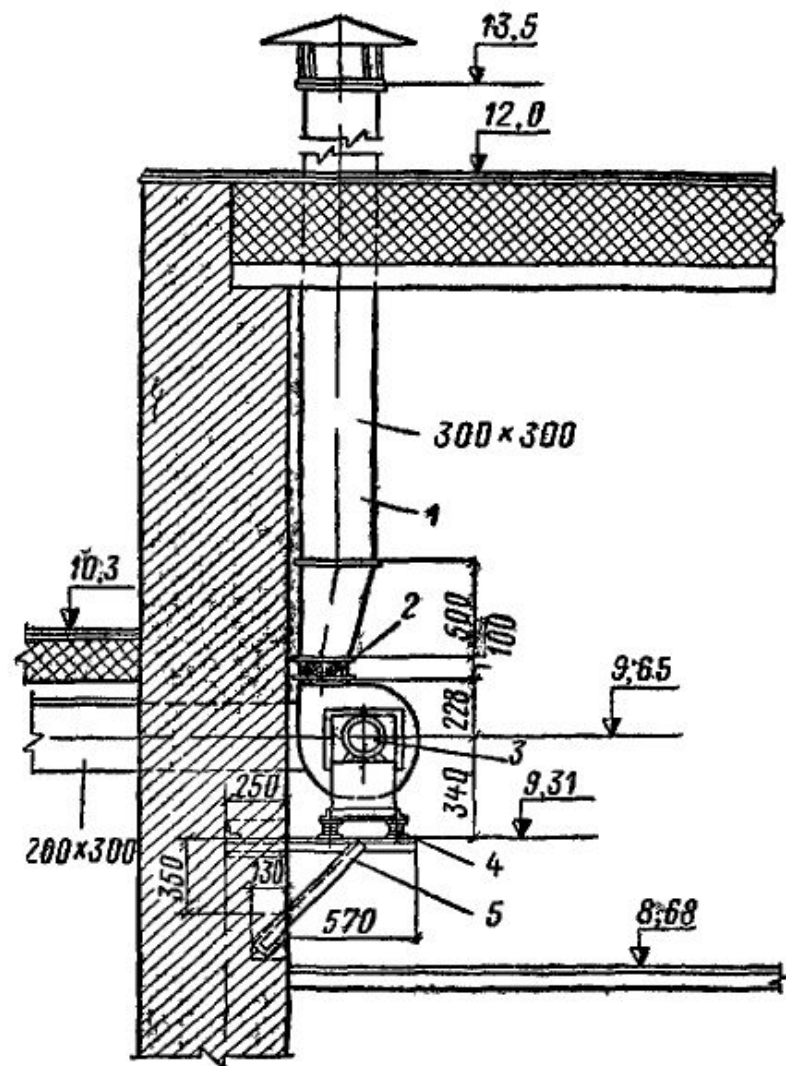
Вытяжной вентилятор, размещенный на кронштейне
